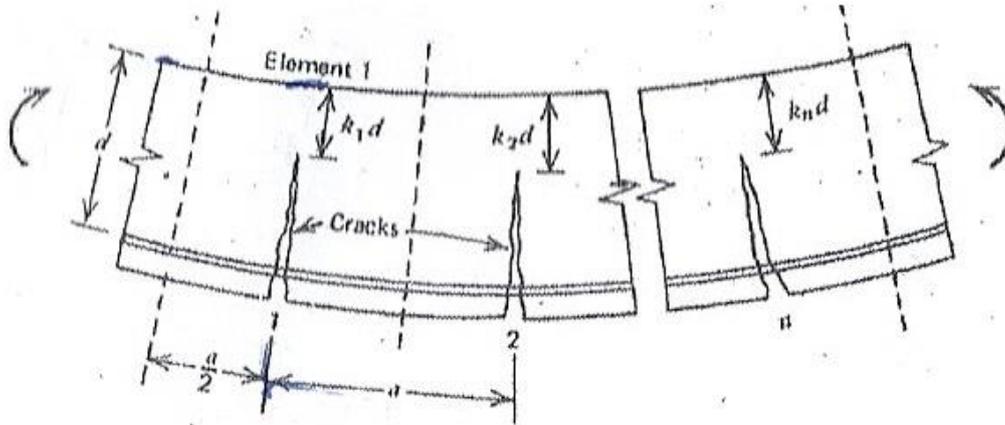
鋼筋混凝土梁之累積變形計算示意圖
